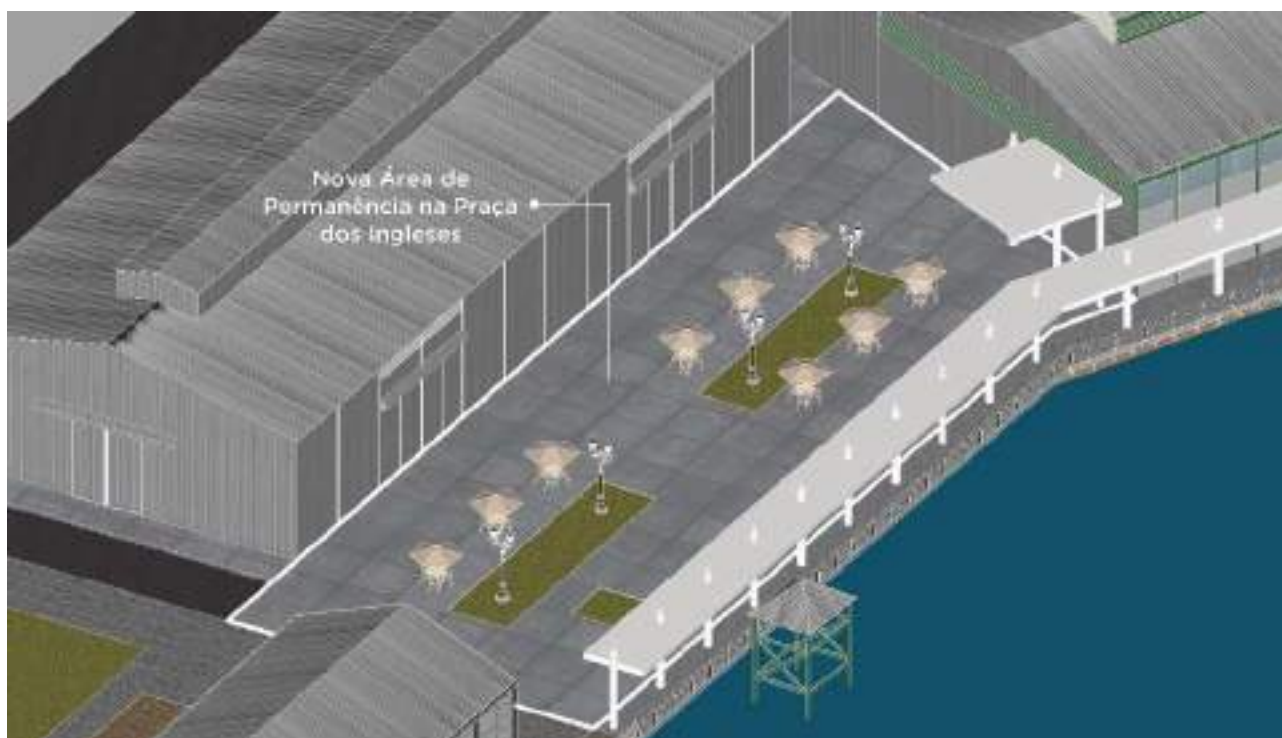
PROPOSTA DE RECONFIGURAÇÃO DA PRAÇA DOS INGLESES.
